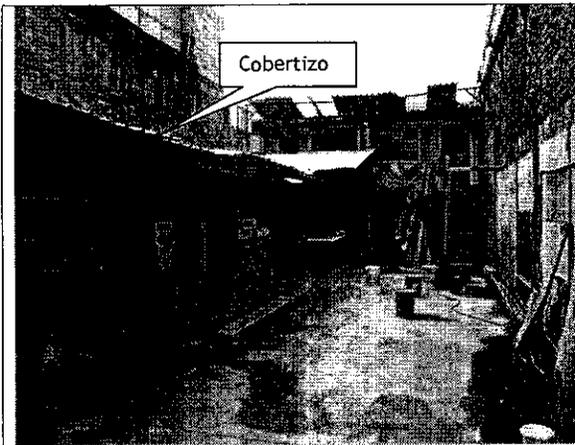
Vista del cobertizo ubicado en la zona media del inmueble; donde se observa la aparente falta de rigidez de los elementos de madera que los conforman.
